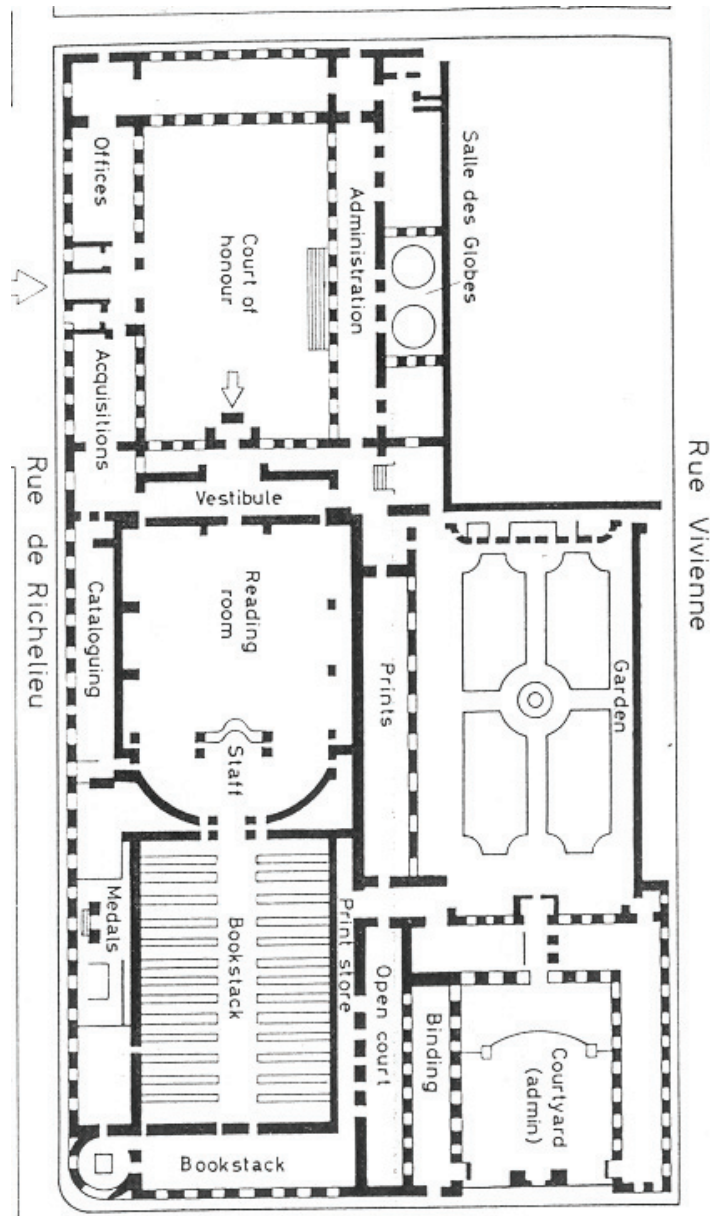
Grundriss Bibliothèque Nationale de Paris (1789)
